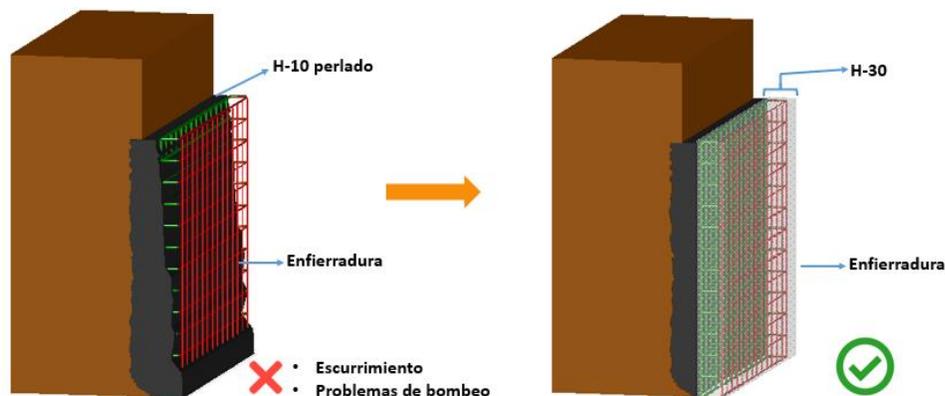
Cambio del tipo de hormigón en el proceso de instalación de muros de confinamiento.
